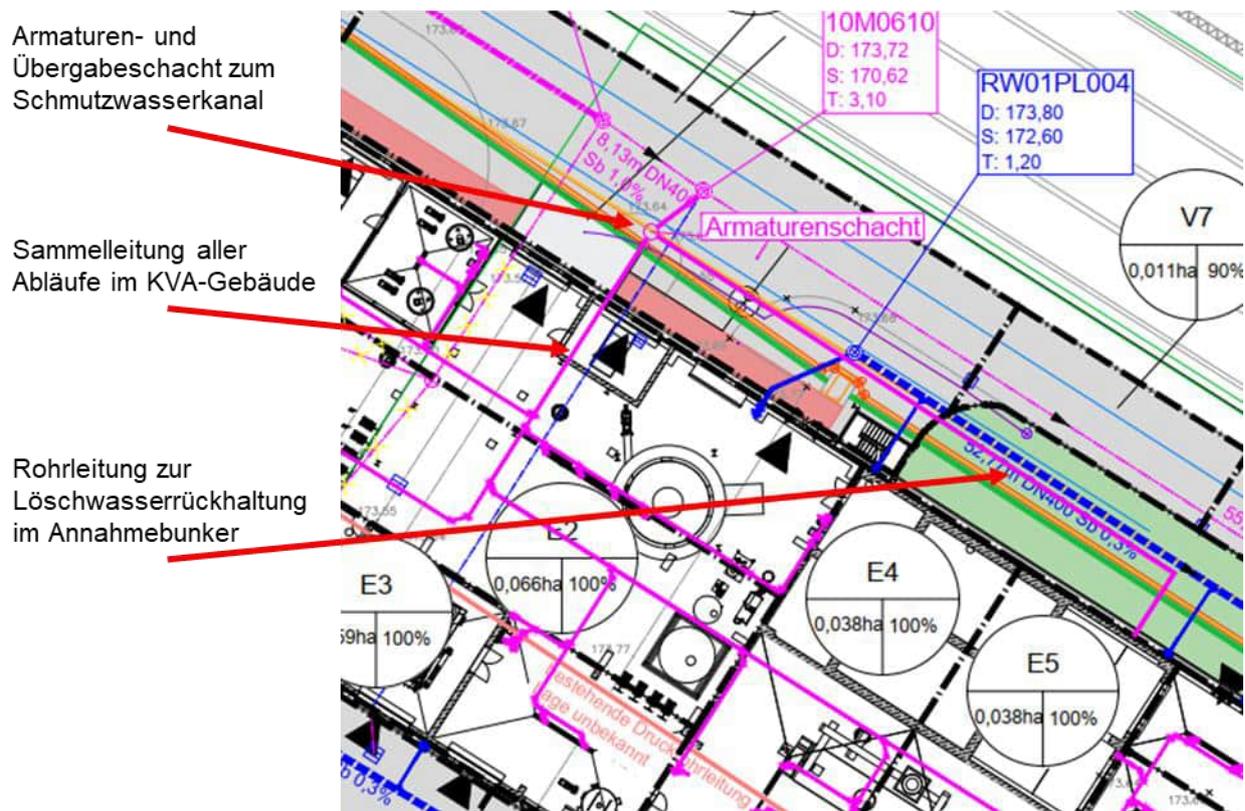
Löschwasserrückhaltung (Ausschnitt Entwässerungsplan)
